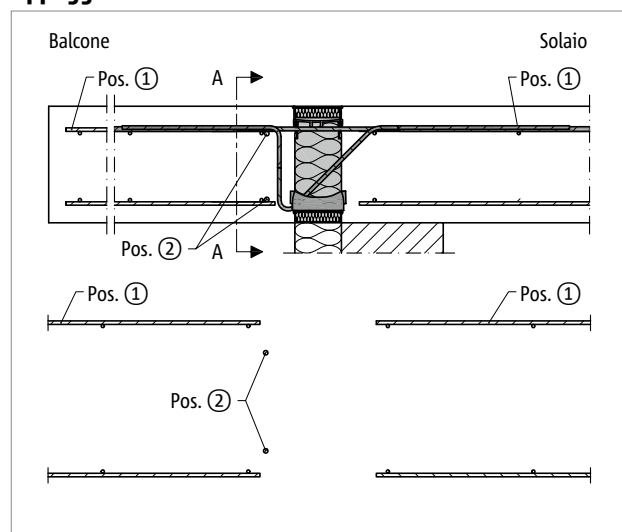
Schöck Isokorb® T tipo KL: armatura in opera con appoggio diretto
